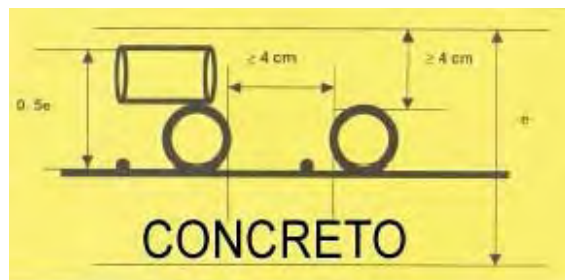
INCORPORACIONES DE TUBERÍAS PARALELAS Y PERPENDICULARES EN LOSAS Y MUROS DE CONCRETO ARMADO
